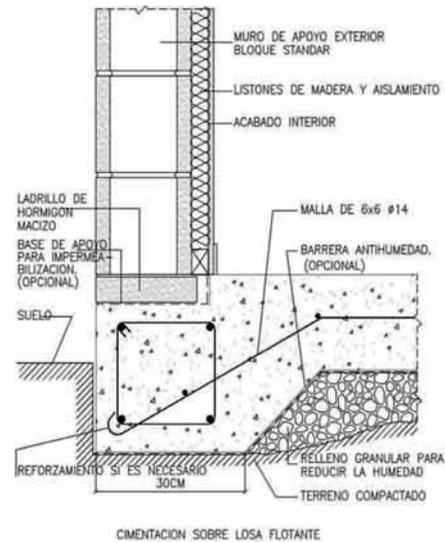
Secciones de arranque de muro de 1 hoja de bloque de carga sobre cimentación de losa flotante.
